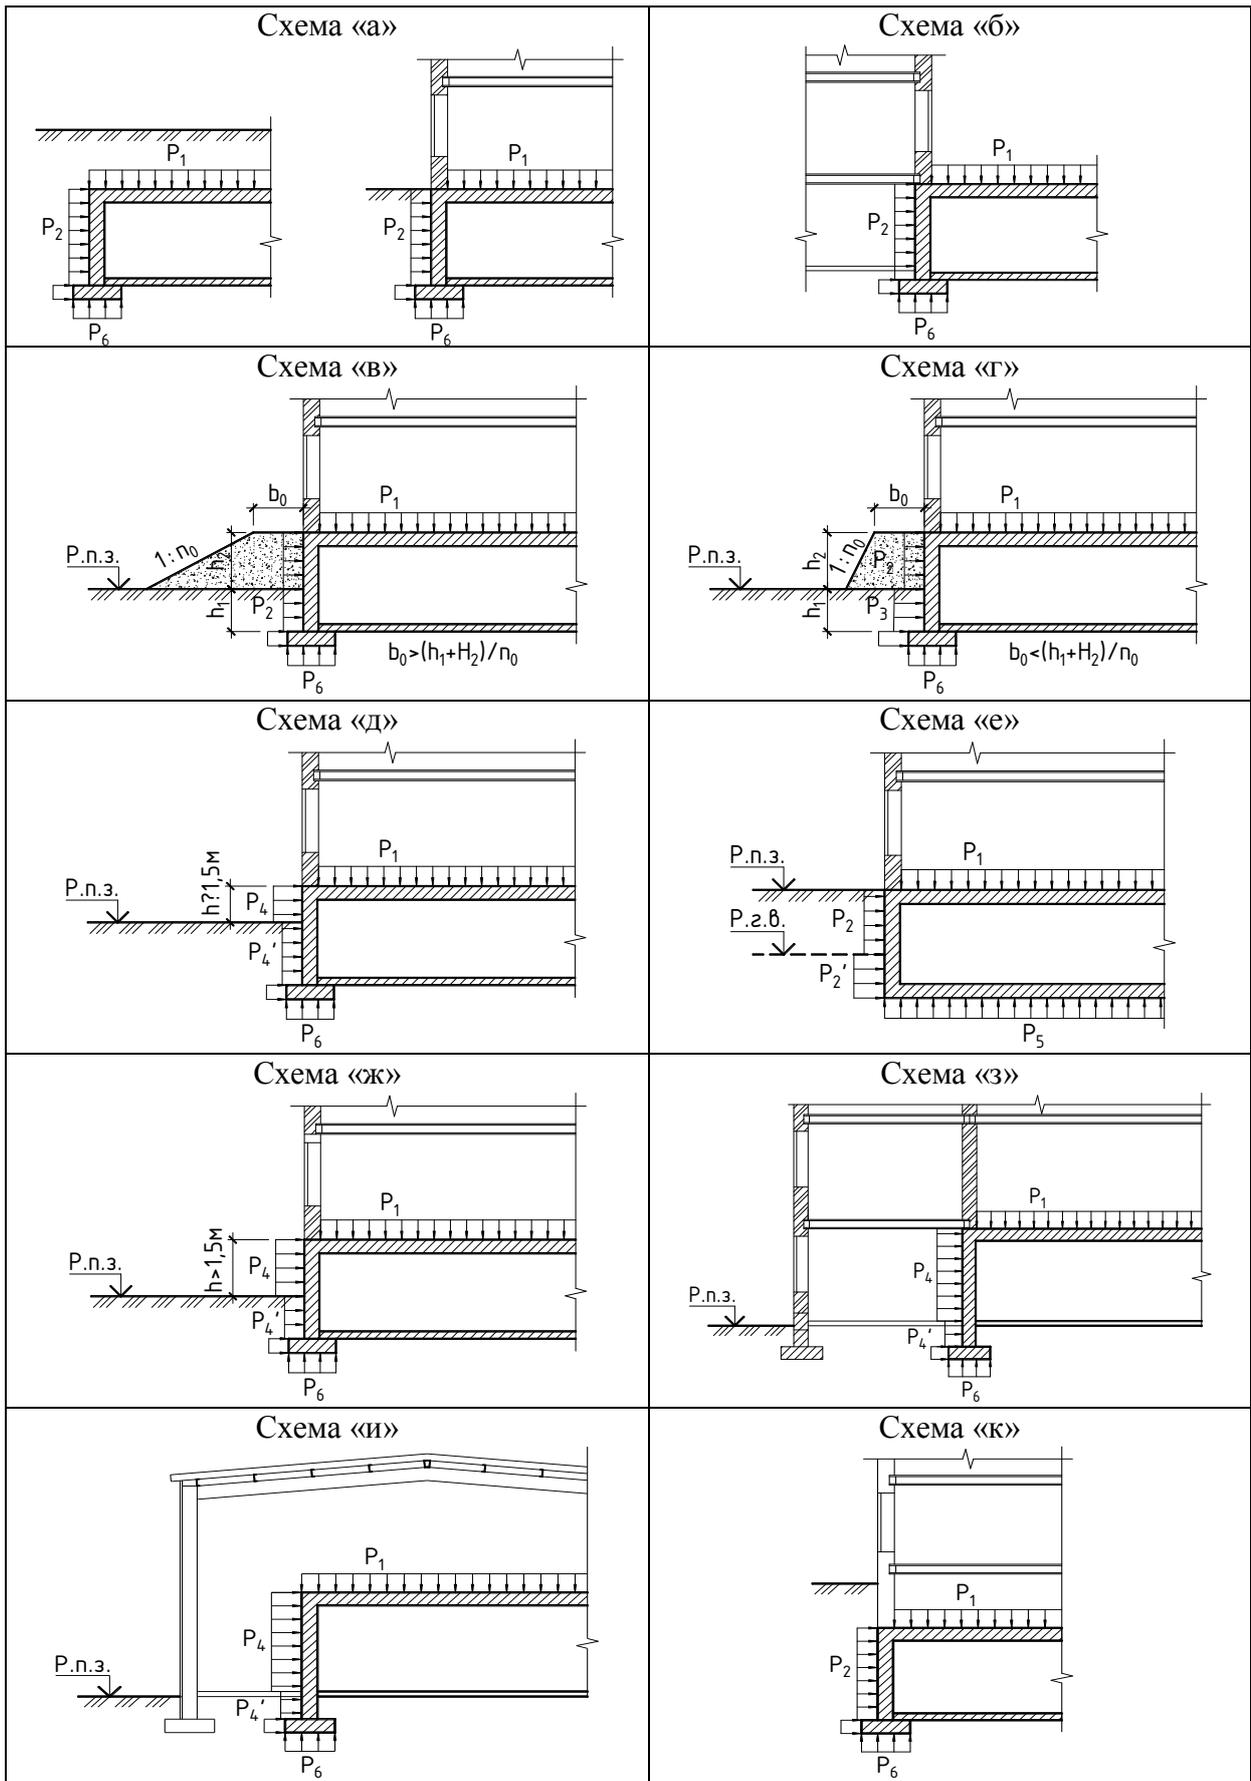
Схеми прикладання приведених навантажень на конструкції захисних споруд та СПП
